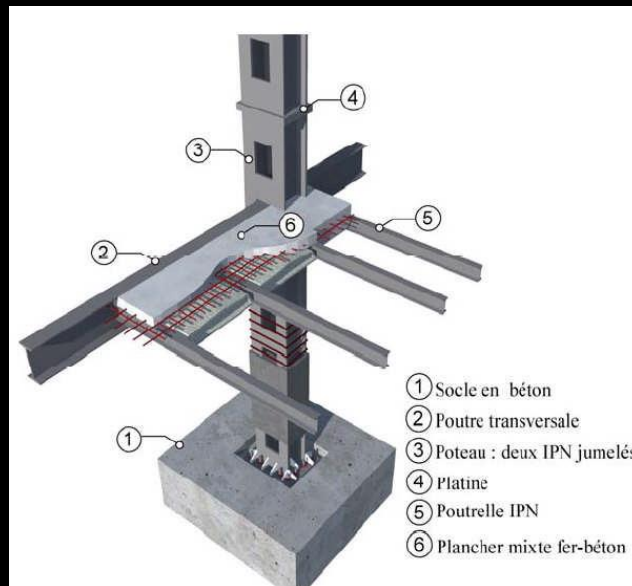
structures métallique ou bien mixte acier-béton
